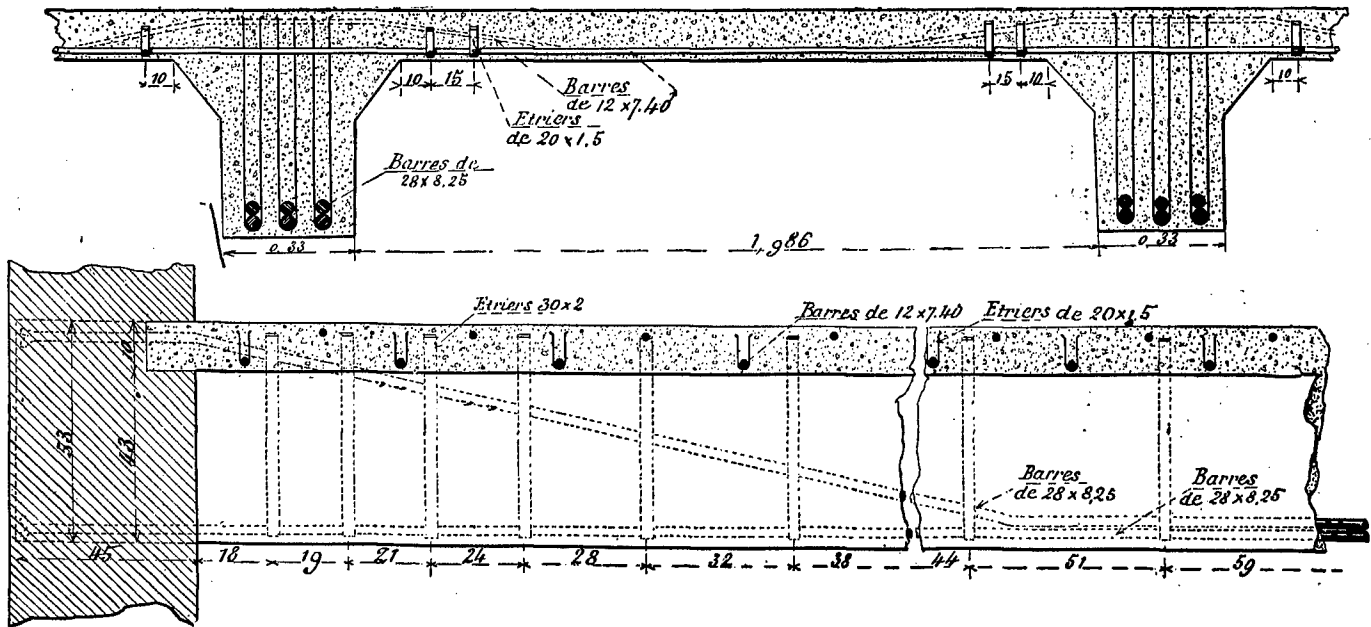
et 13. — Plancher en béton armé (deuxième type en poutres).
